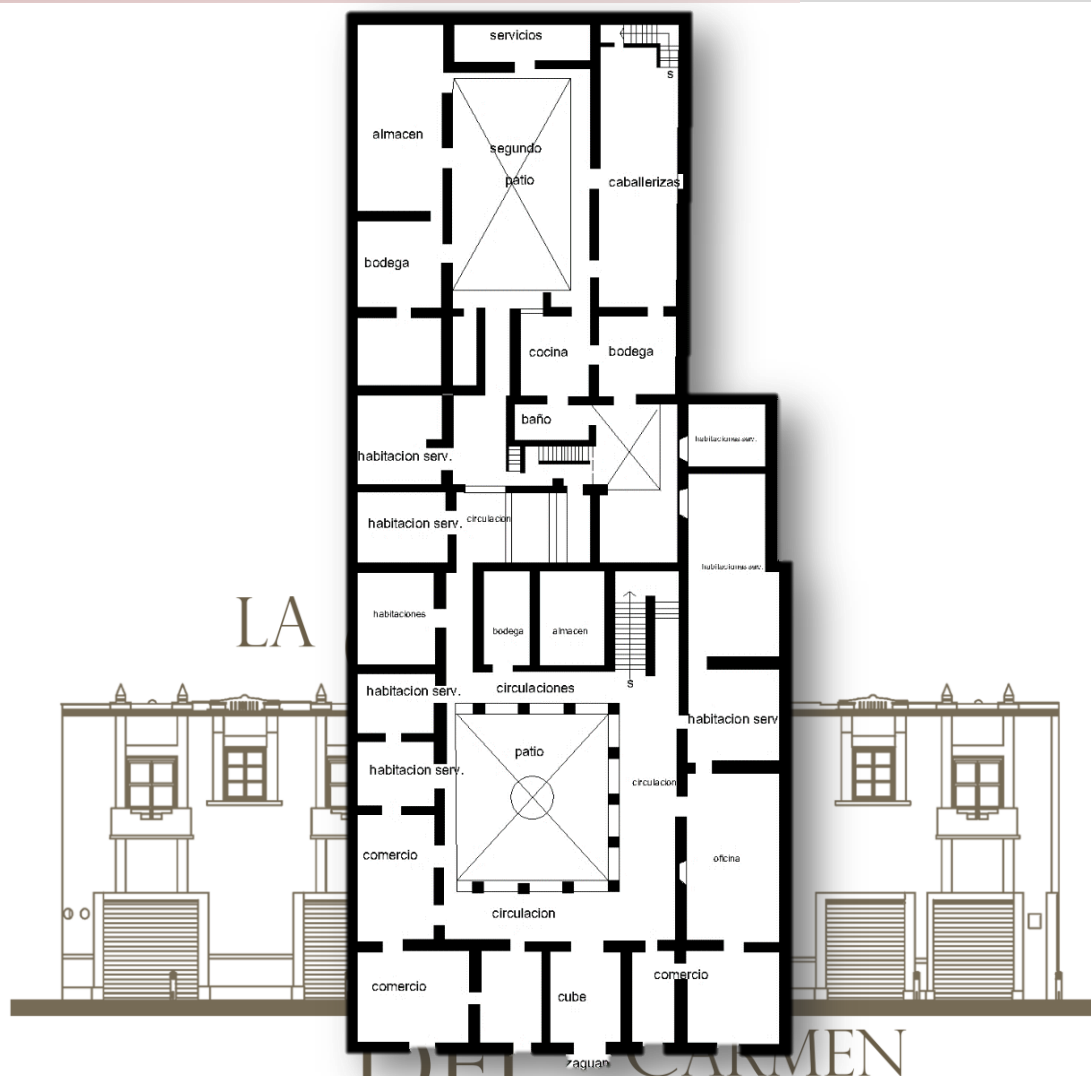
Modelo arquitectónico de la casona del #406 de la Calle 4 Oriente, siglo XVII.
